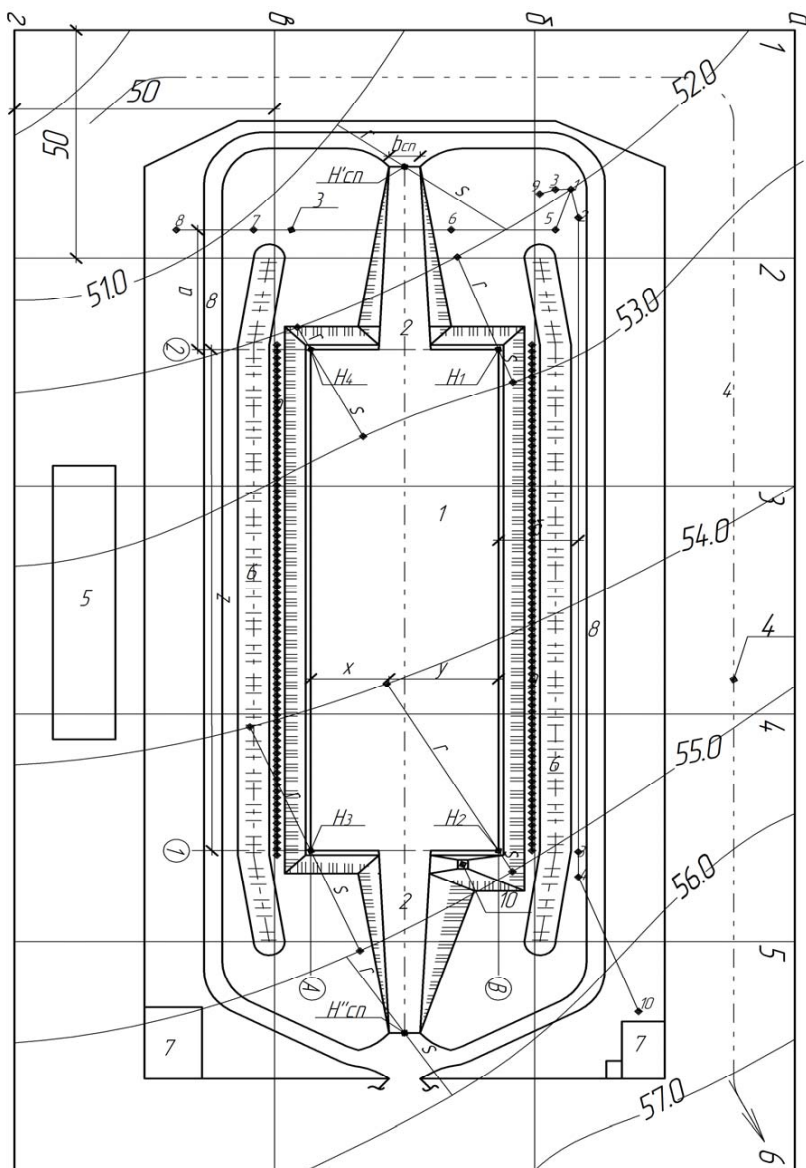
План строительной площадки: 1 – котлован; 2 – спуск в котлован; 3 – створные знаки и реперы; 4 – нагорная канава; 5 – склад растительного грунта; 6 – кавальеры; 7 – склады и бытовки, санузлы; 8 – дорога; 9 – забор; 10 – зумпф
